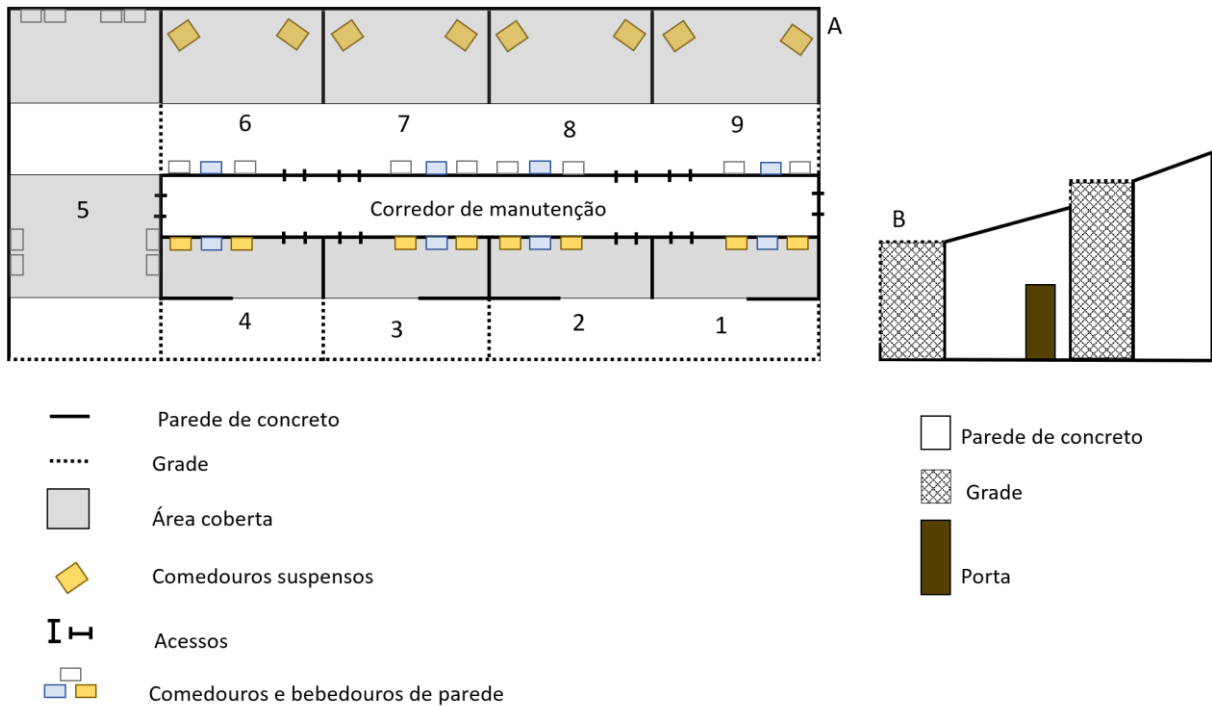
Planta viveiro: A – Vista de cima do viveiro. B – Vista lateral do viveiro.
